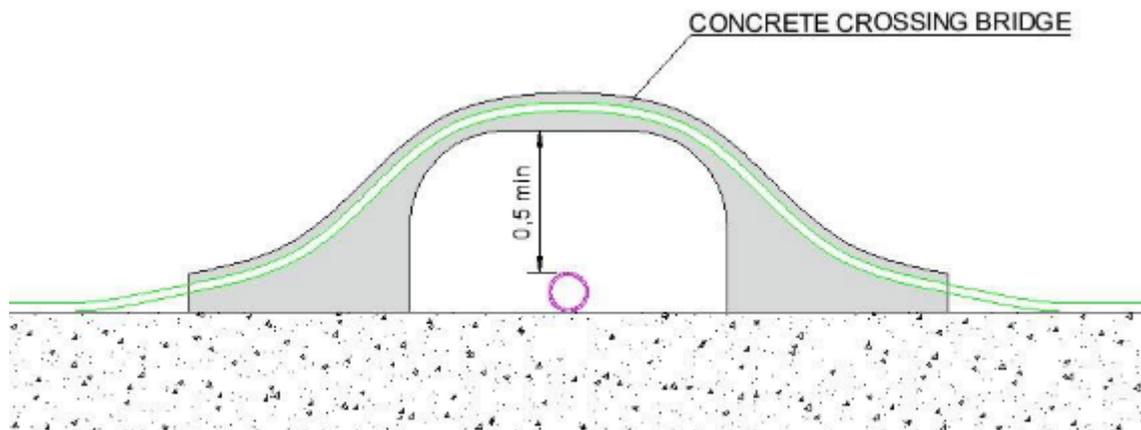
Esempio di scavalco di una condotta affiorante con concrete bridge
